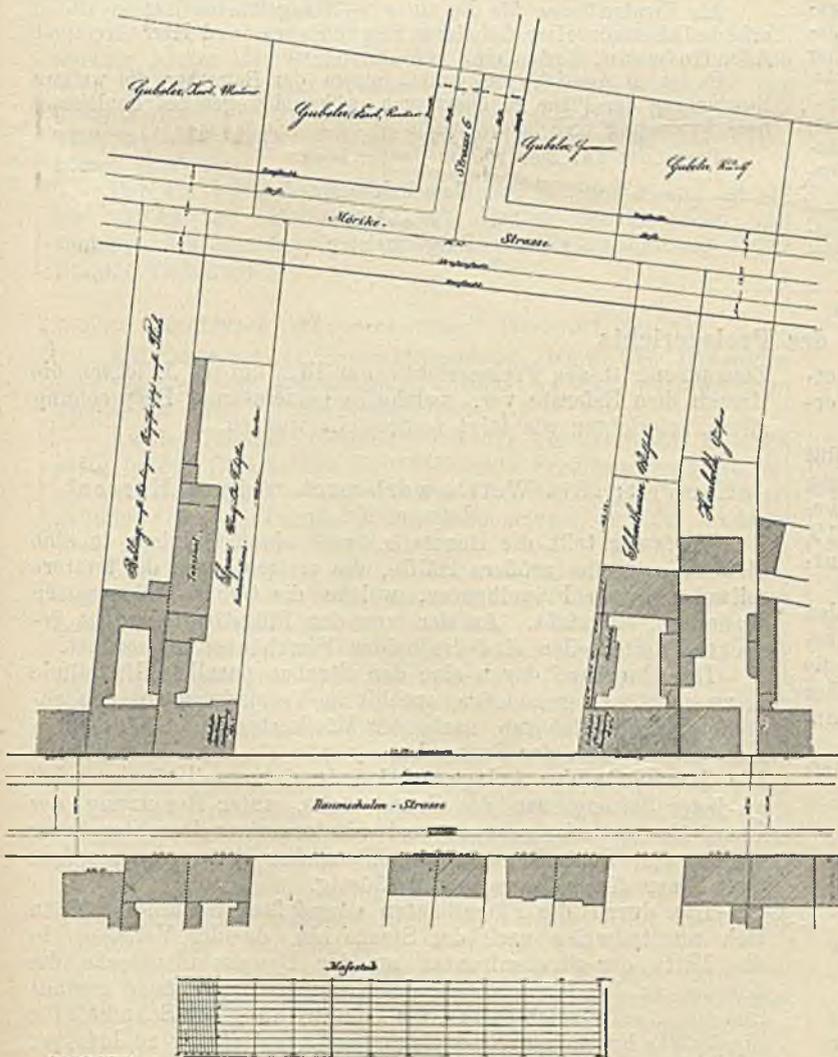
Lageplan des der Landgemeinde Treptow gehörigen Grundstückes an der Baumschulenstraße
